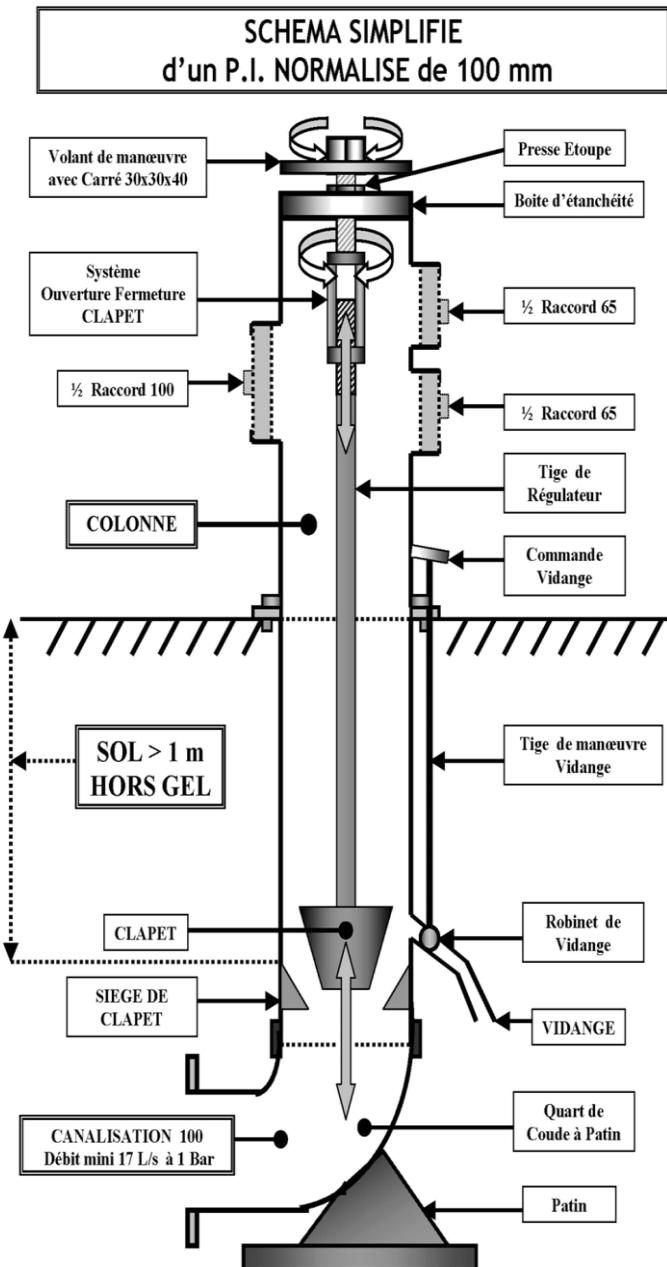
Exemples de poteau sur canalisation de 100
